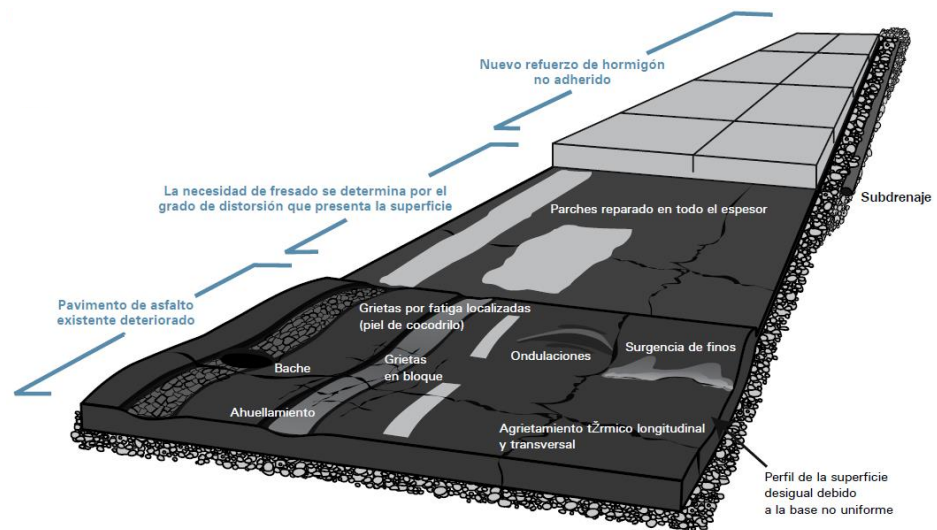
Whitetopping no adherido de un pavimento flexible en condiciones malas a deterioradas.
